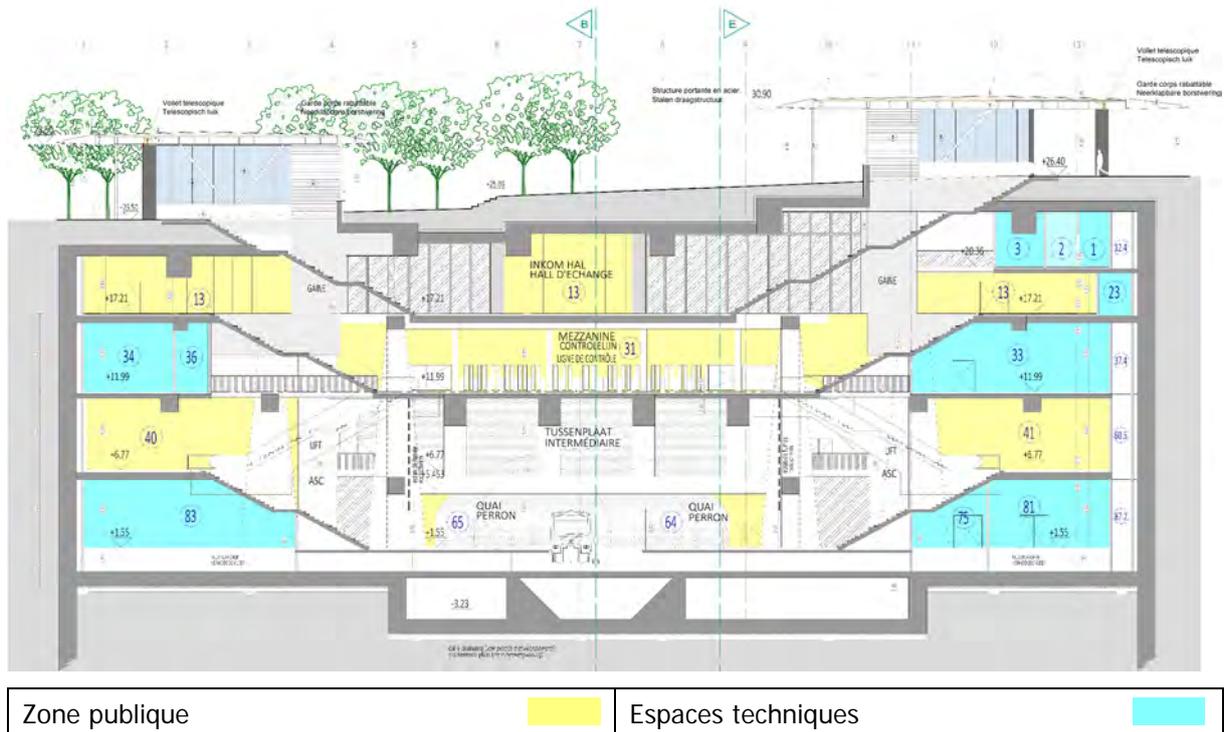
Station Liedts, coupe transversale (BMN, 2018)
